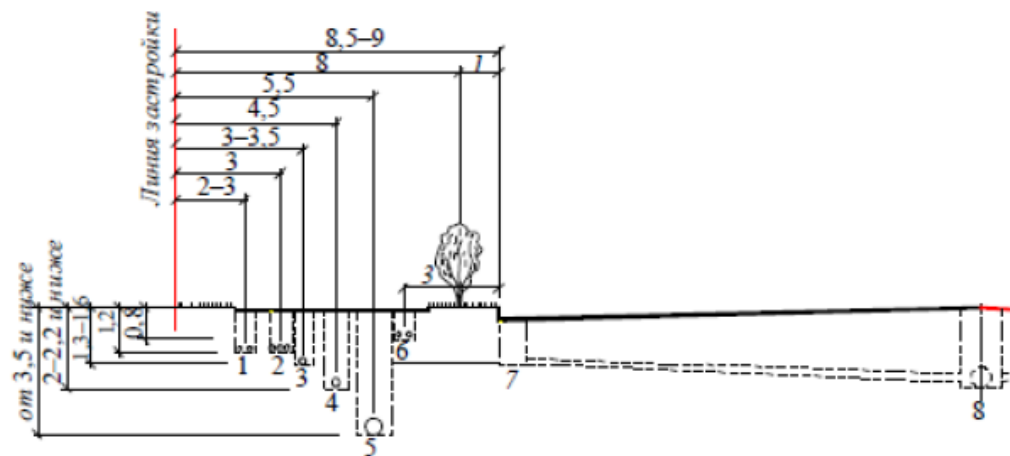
Пример прокладки инженерных сетей в поперечном разрезе улицы (трасса водостока запроектирована по оси улицы): 1 — кабель связи; 2 — теплопровод; 3 — газопровод; 4 — водопровод; 5 — канализация; 6 — кабели наружного освещения; 7 — водоприемник; 8 — водосток
